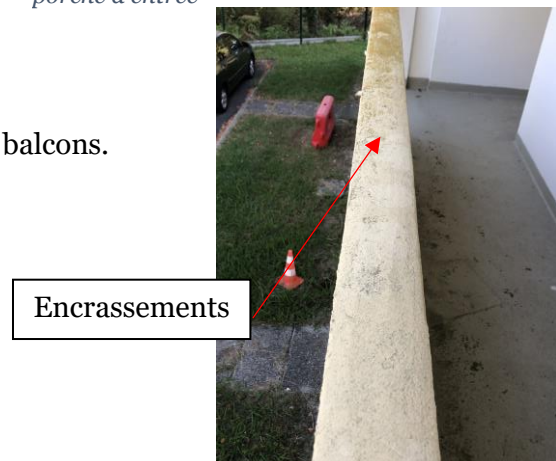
Encrassement du mur garde corps d'une loggia ouest
